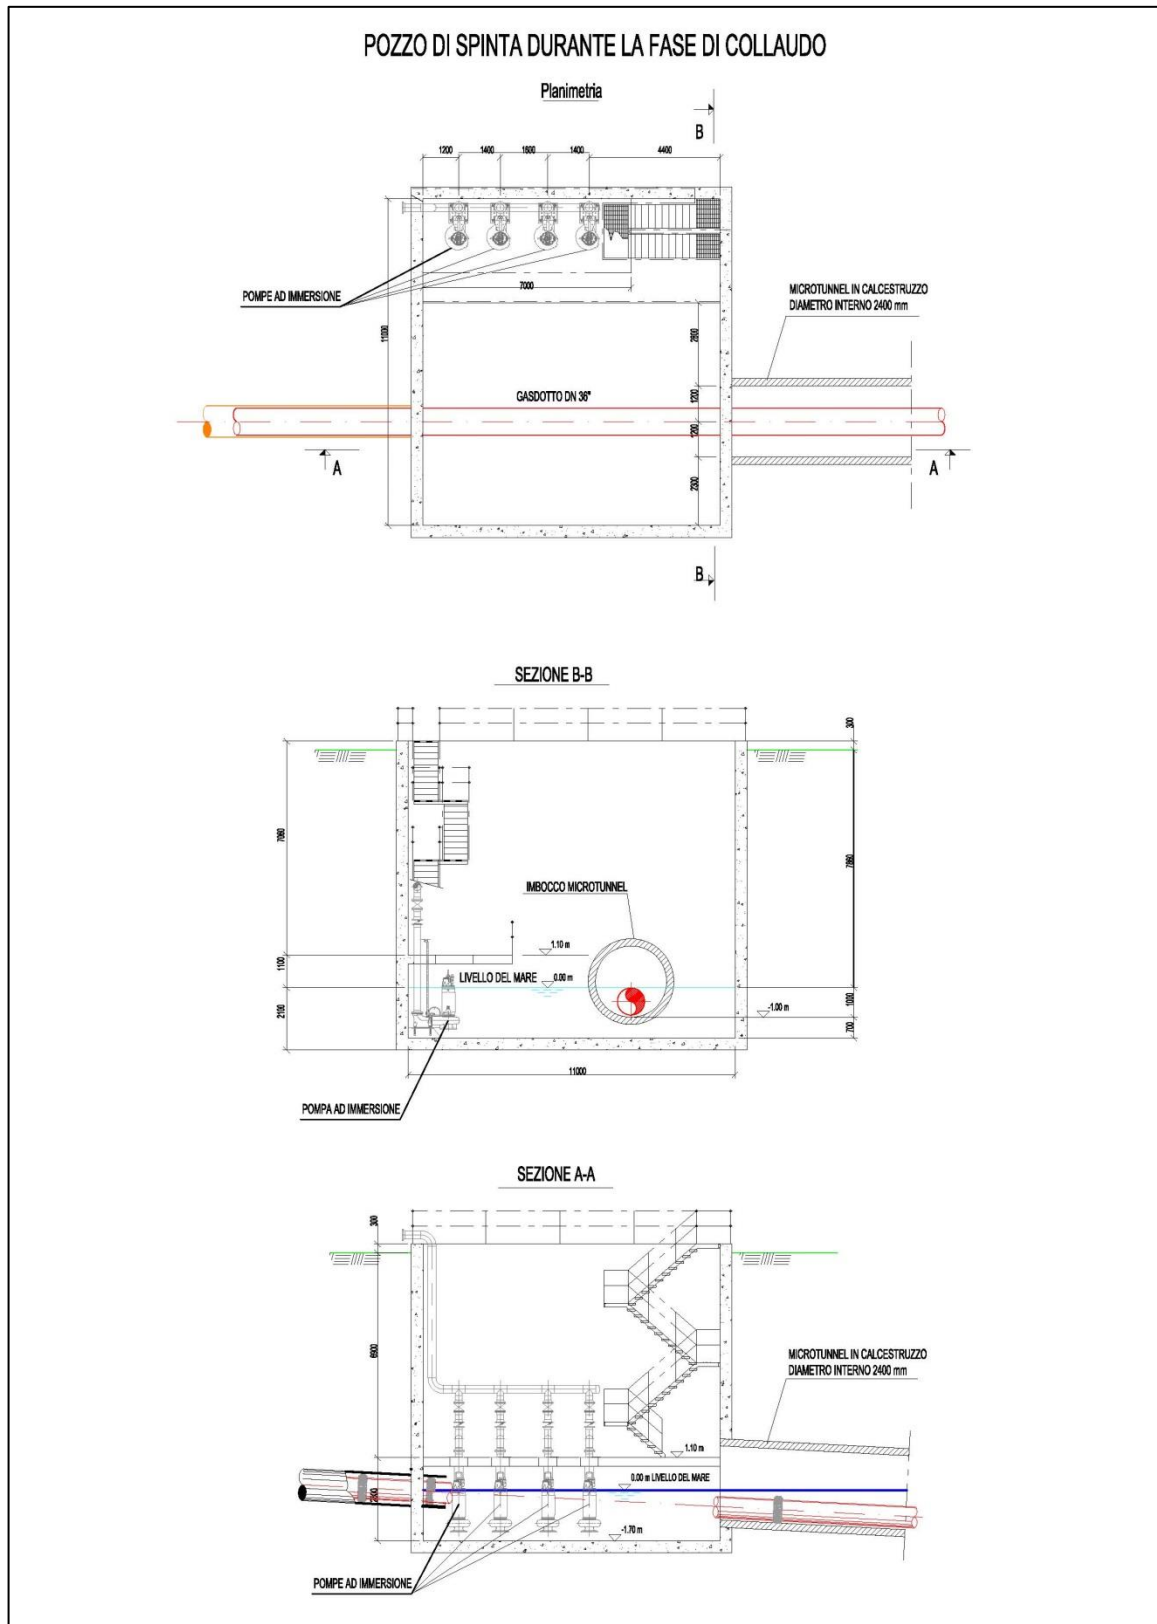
Planimetria e sezioni generali del sistema di pompaggio all'interno del pozzo di spinta
